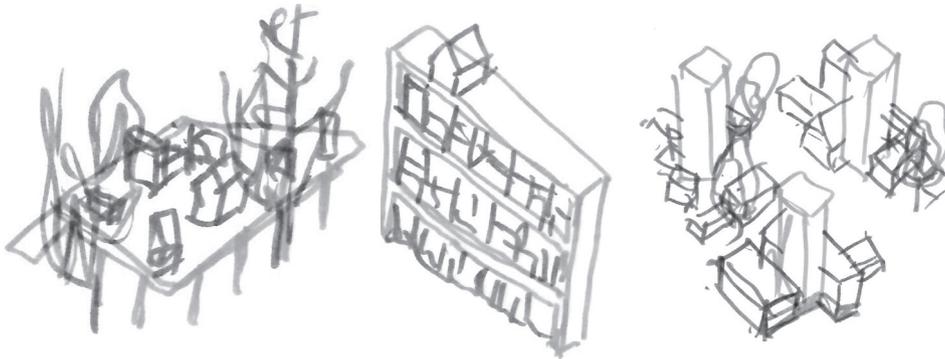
Verschiedene Grundbau und Ausbau Varianten
